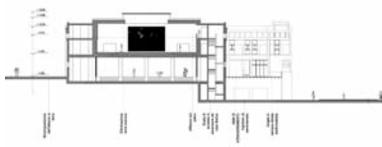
Sezione trasversale aula consiliare. Ipotesi di progetto
